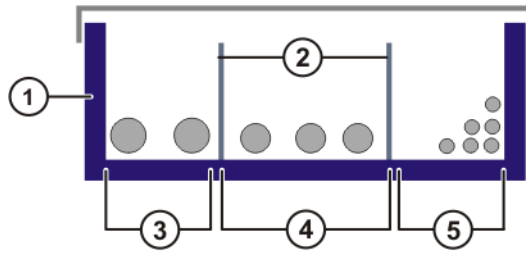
Exemple : Pose des câbles dans la conduite de câbles
